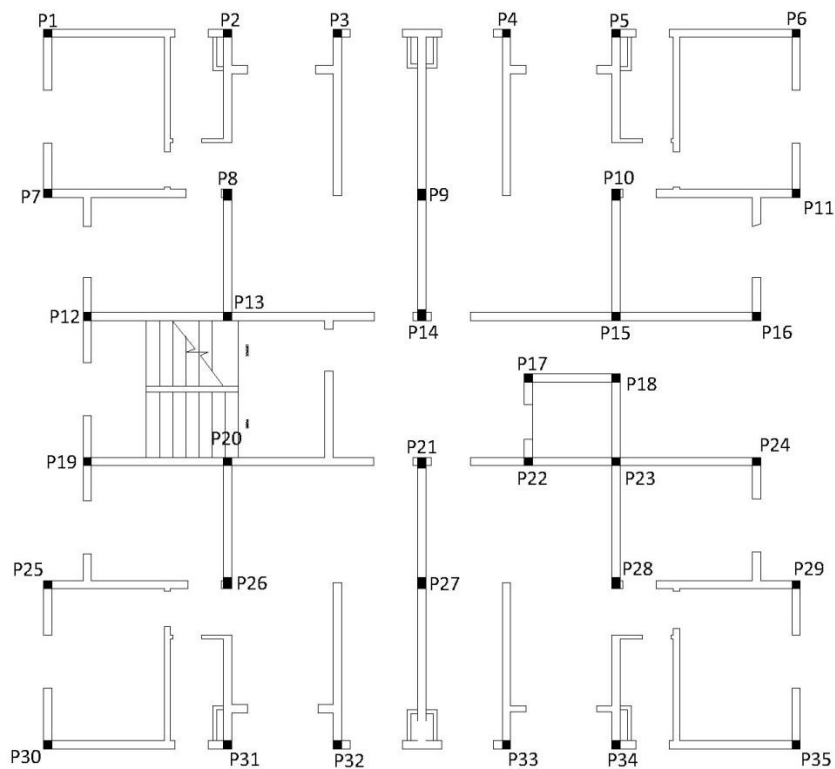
Localização dos pilares da primeira concepção estrutural (Fonte: autor próprio)
